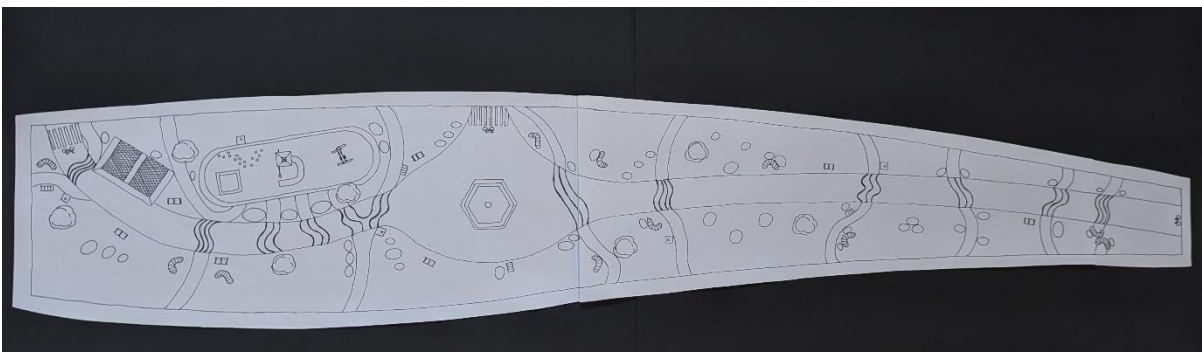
Grundriss auf Papier mit schwarzem Fineline
